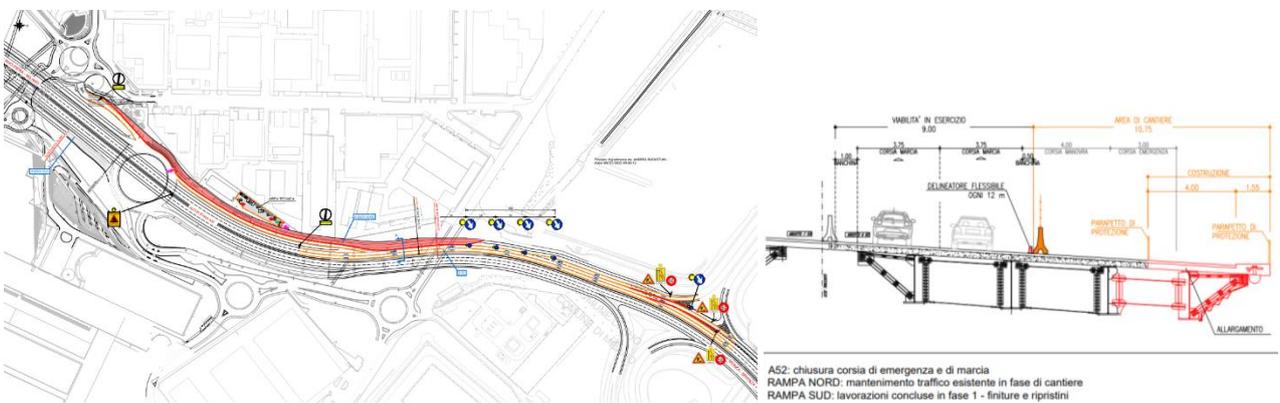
Planimetria delle cantierizzazioni 2/3 (Fonte Allegati alla Lista di controllo)
